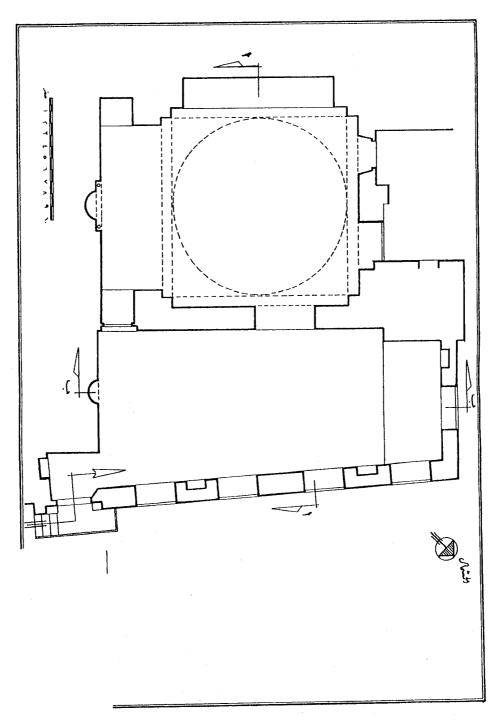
مسقط أفقي لزاوية الدمرداش بالعباسية (عن : درويس أبو سيف) .
